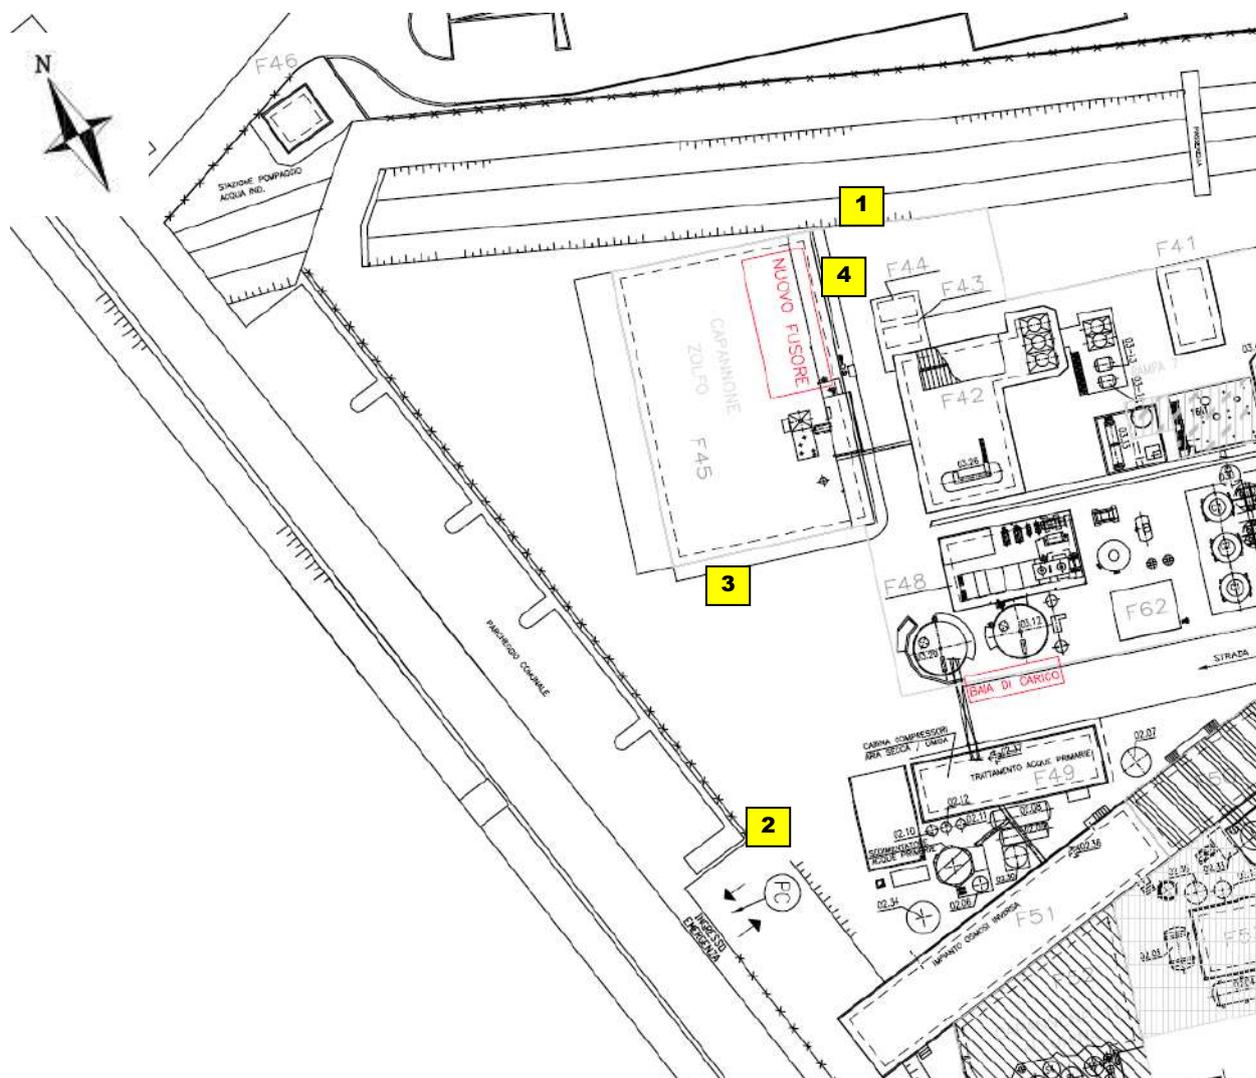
planimetria dello stabilimento ed ubicazione del Capannone 14.
